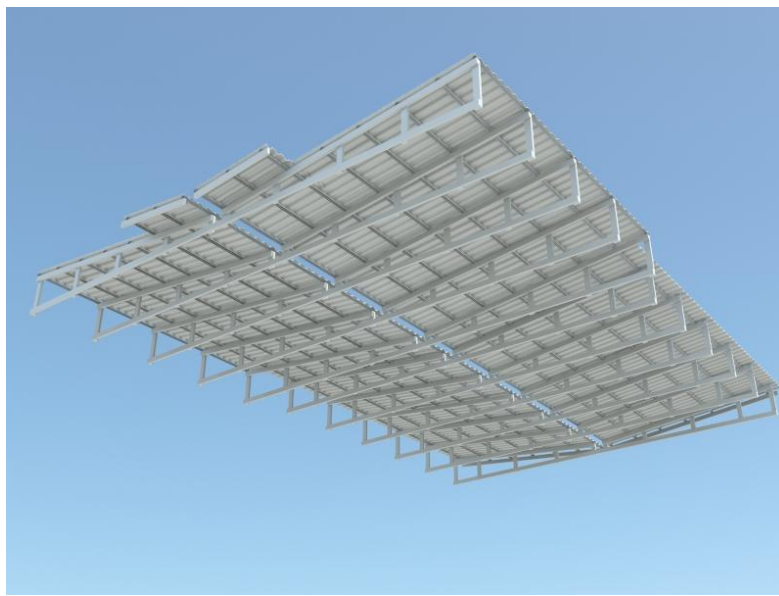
Modelo de telhado com steel frame e telha termoacústica. Acessado em 18/11/2018. Fonte: <http://tdprojetos.blogspot.com/2012/05/telhado-do-novo-residencial.html>
